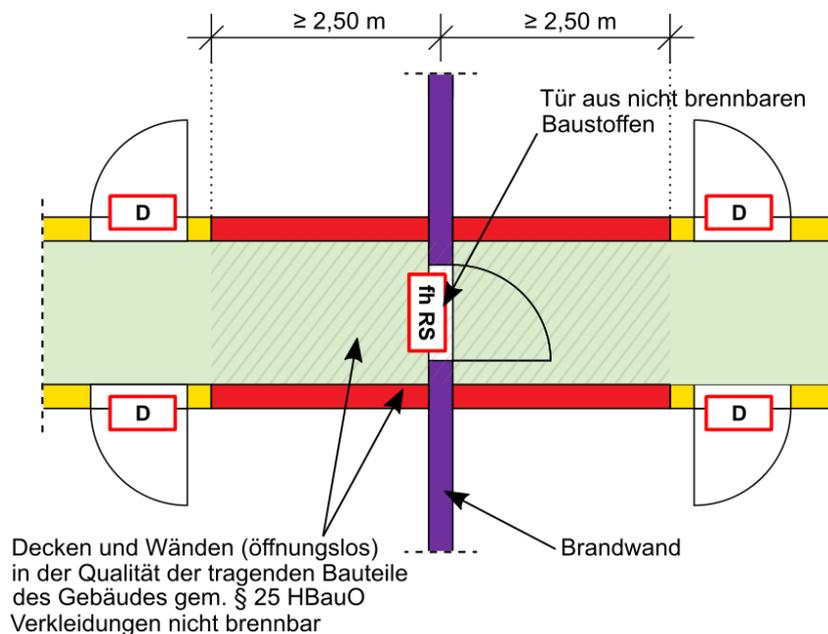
Prinzipskizze (Grundriss) - Variante 1: Abschluss mit einer Tür
